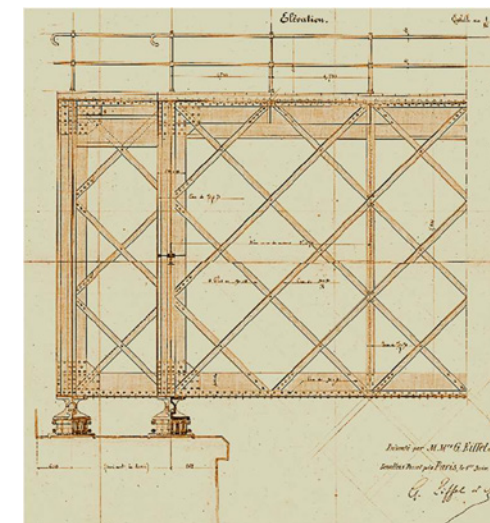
Pormenor das vigas principais da Ponte sobre o Rio Cávado, em Barcelos [4]
